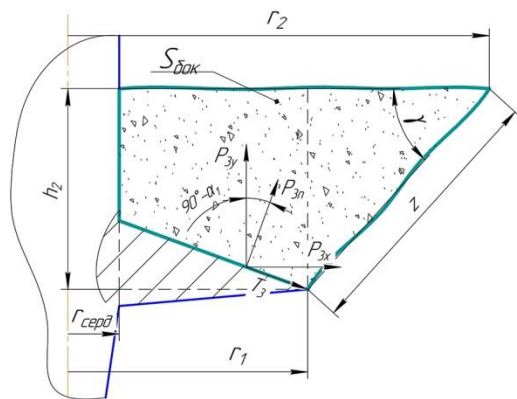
Схема для определения необходимого усилия на отрыв грунта
